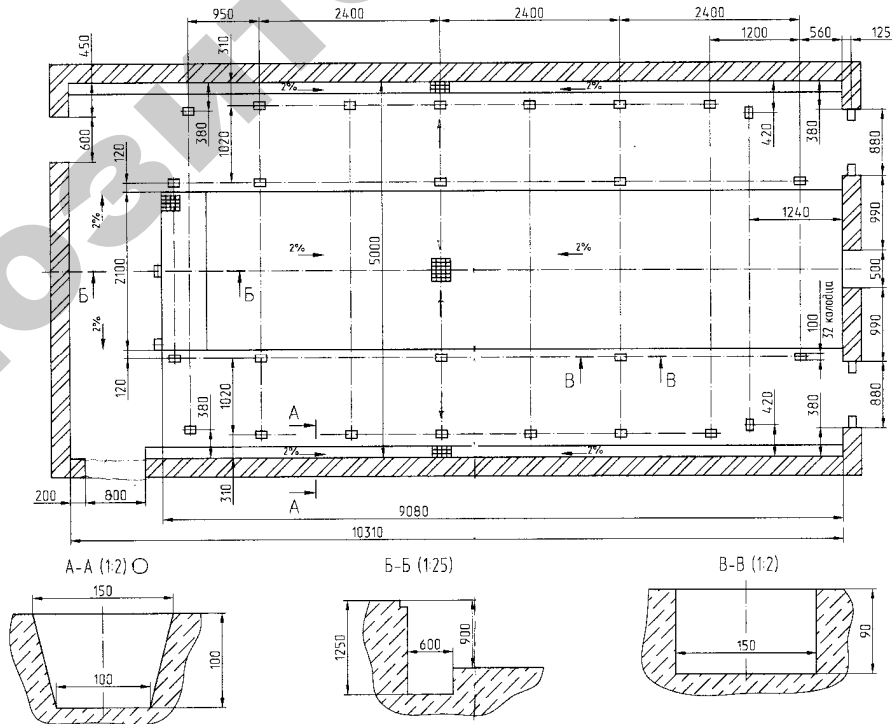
Планировка доильного зала с доильной установкой УДА-12Е
